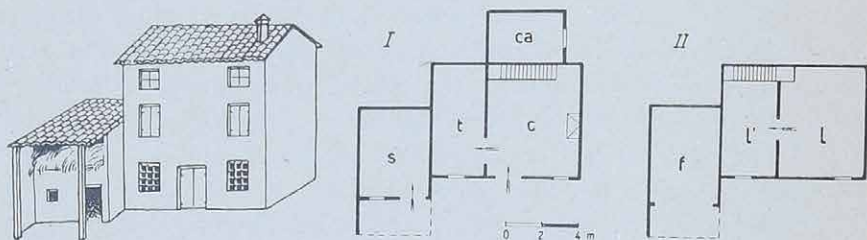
Abitazione tipica della Val di Chiampo: prospetto e planimetria del pianterreno (I) e del 1° piano superiore (II).
